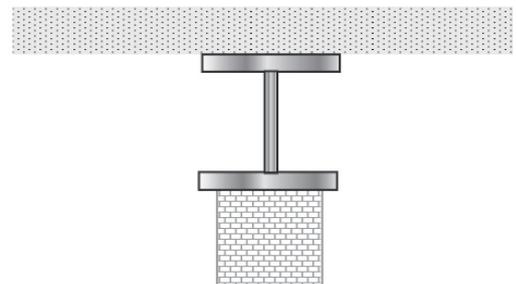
viga de aço com laje de concreto e sobre alvenaria (corte)
